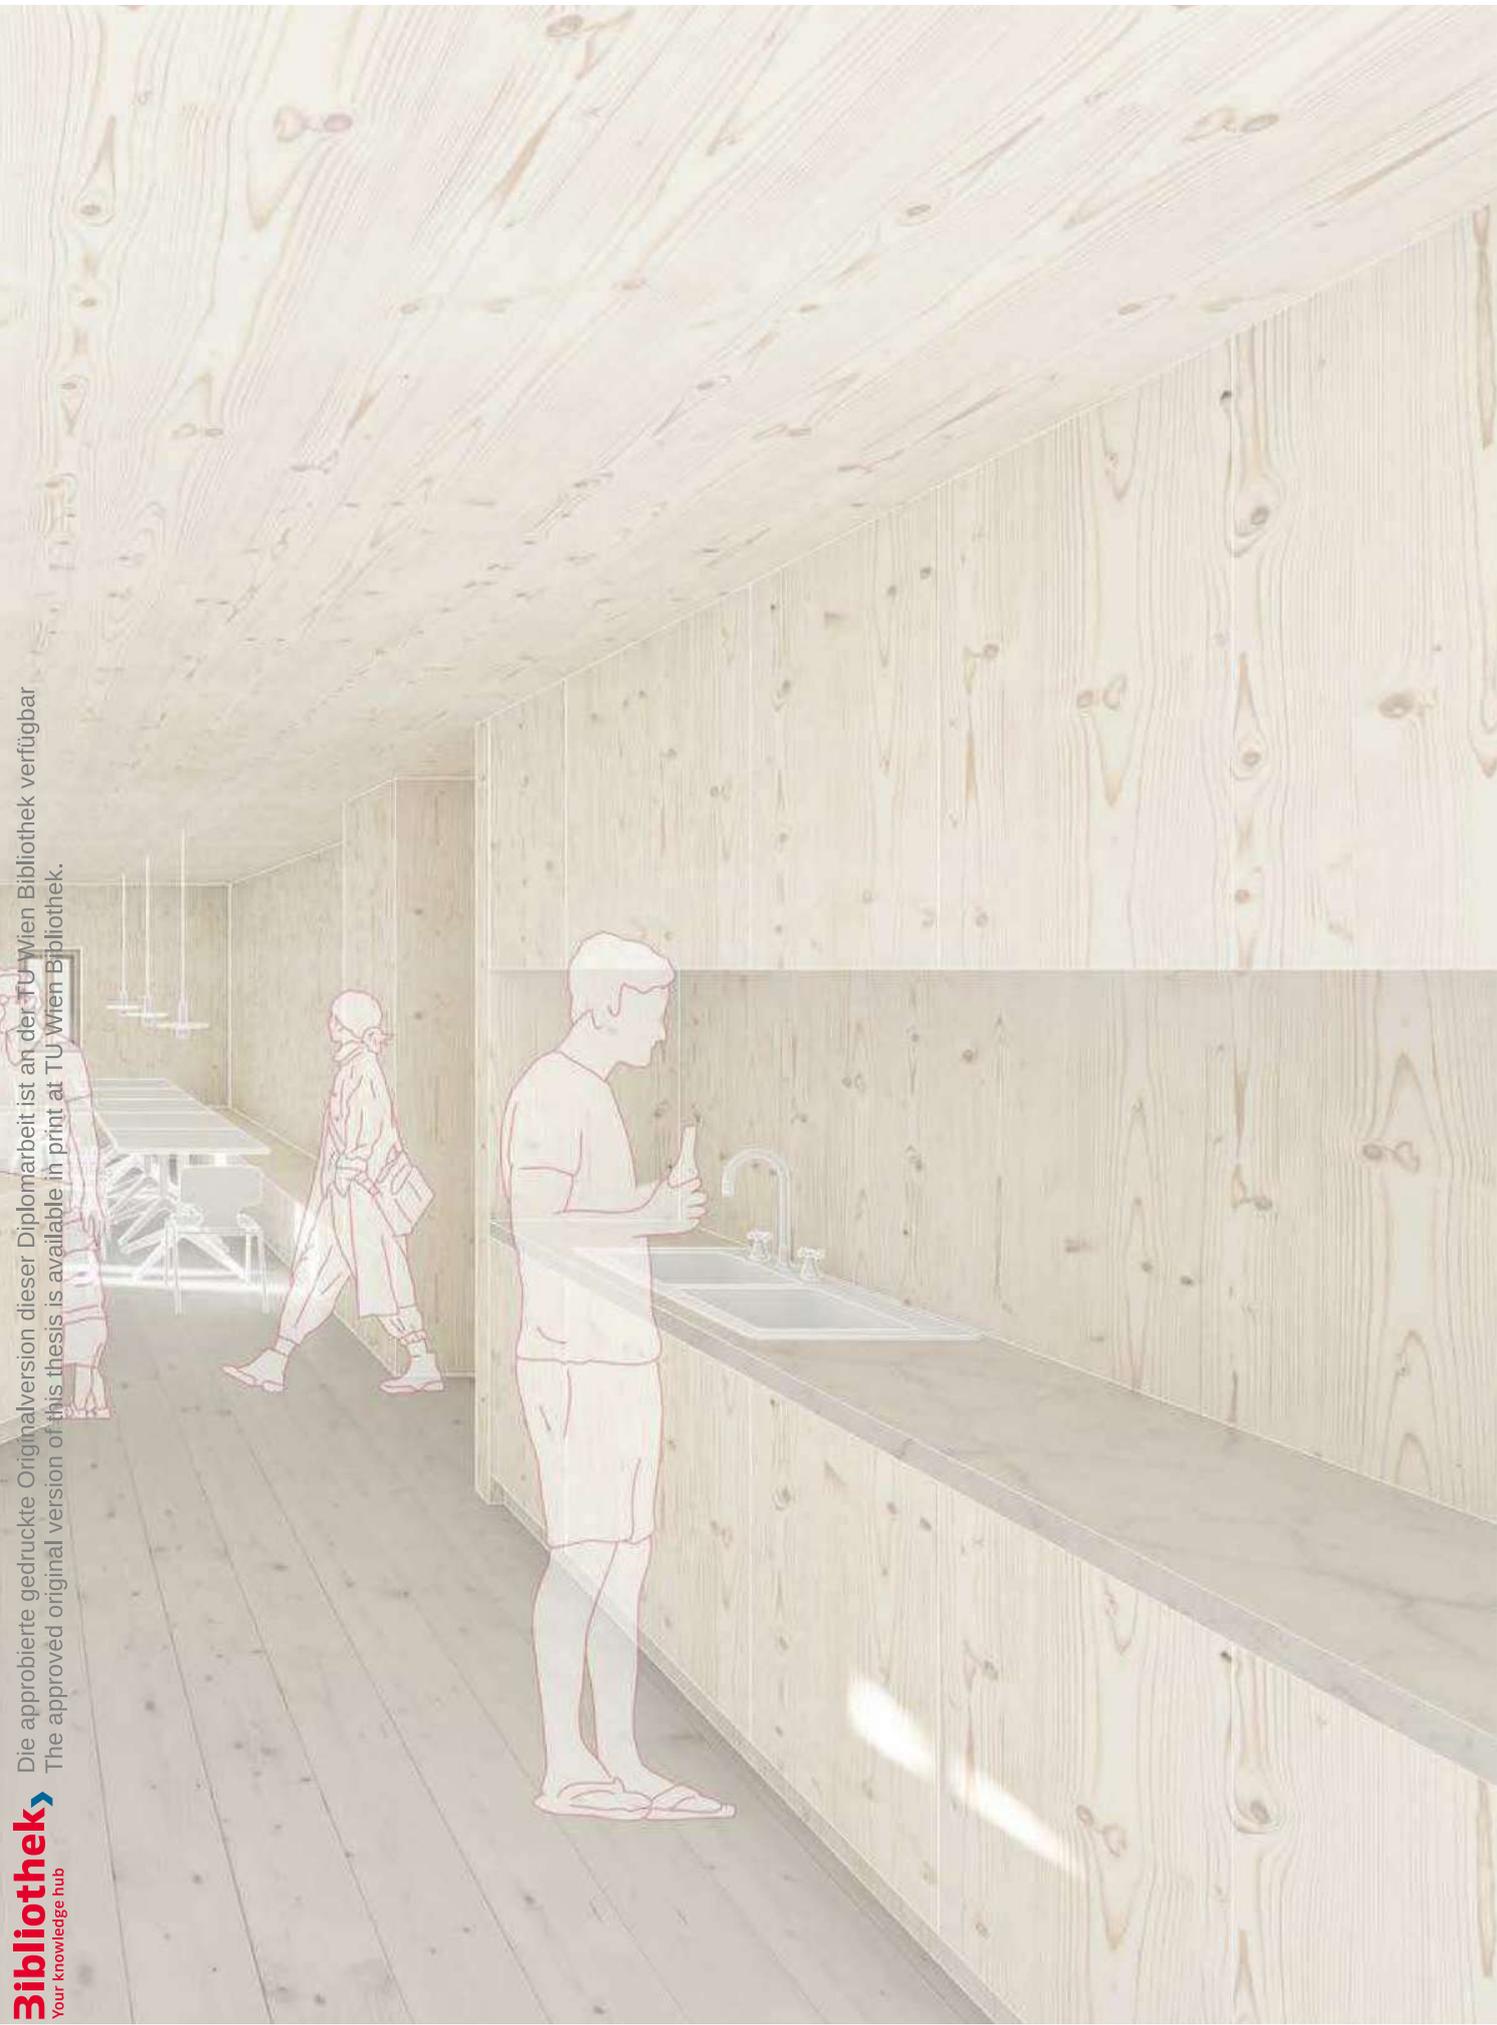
Wohnraum der Atelierwohnungen, Dachgeschoss
